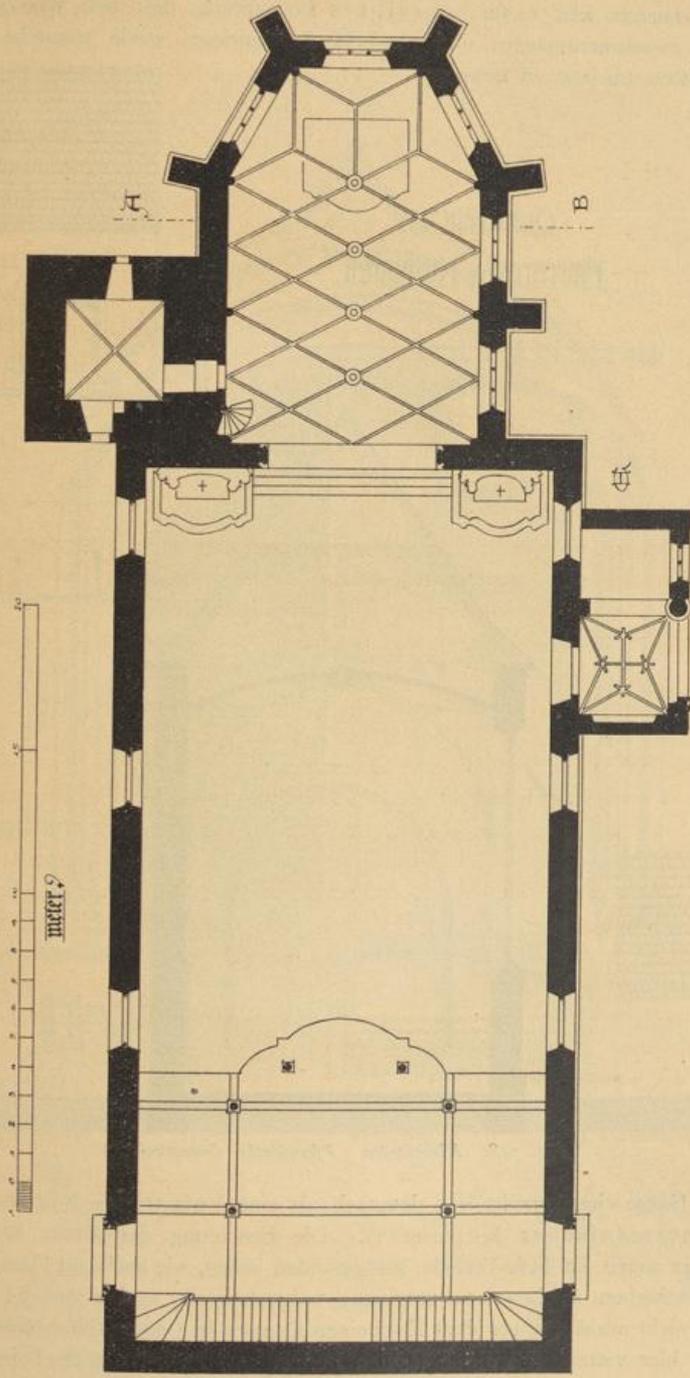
Kirchzarten. Pfarrkirche, Grundriß.
